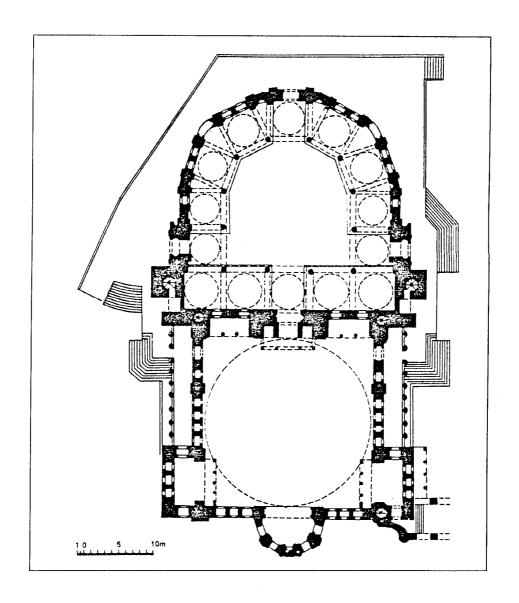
مكرر) مسقط أفقي لمسجد بايزيد الثاني في ادرنة (عن :Müderrisoğlu) .
